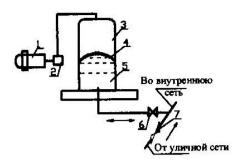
Пневматическая установка с одним баком: I — компрессор; 2 — фильтр; 3 — воздушная часть бака; 4 — резиновый экран; 5 — водяная часть бака; 6 — запорная арматура; 7 — обратный клапан
